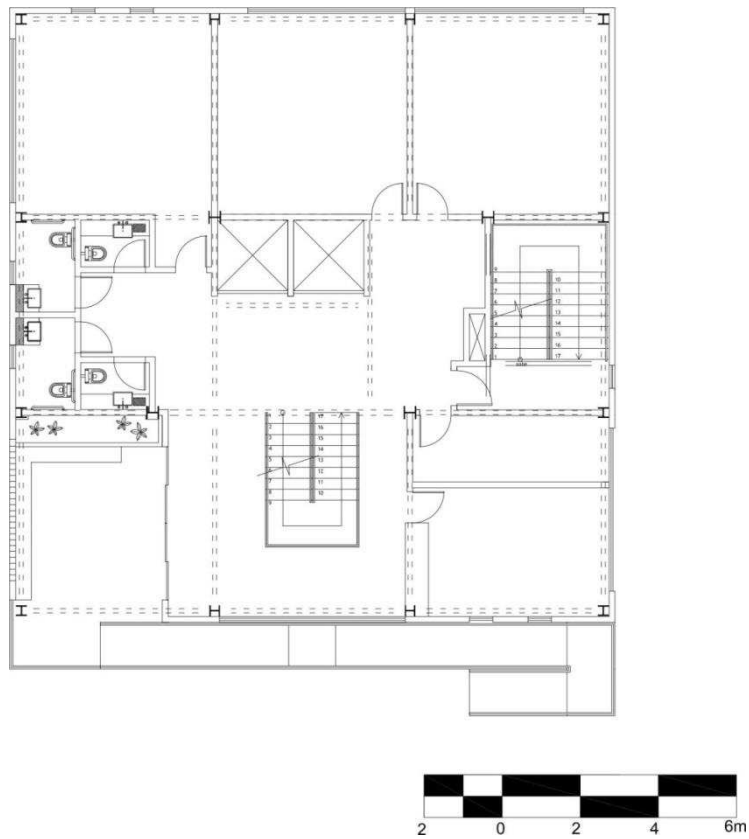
Planta baixa do pavimento térreo o Edifício da obra social da IPV.
